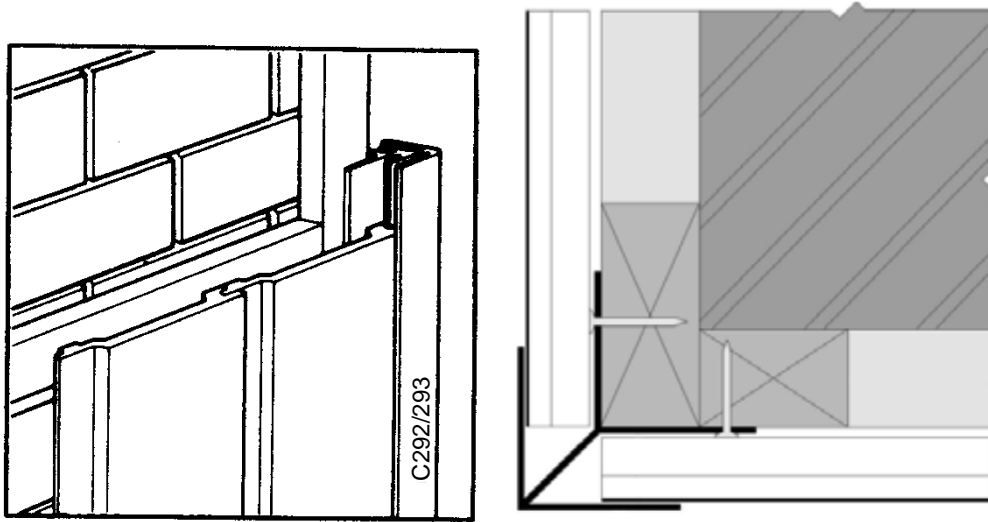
Disposition verticale sur façade et pignon de maisons individuelles R+1 maximum
